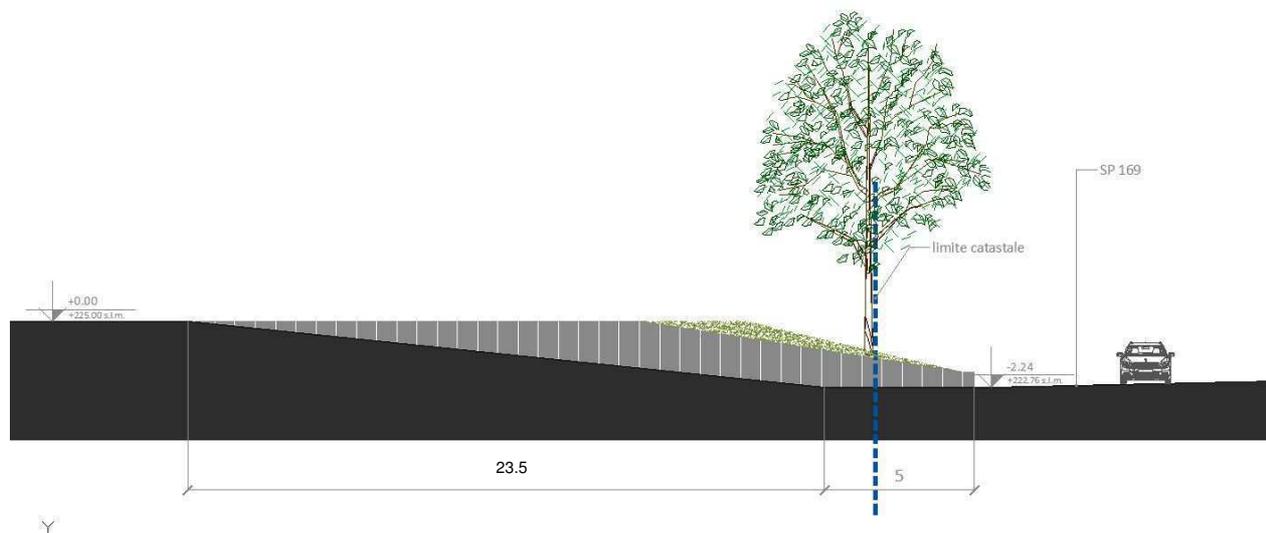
sezione dell'innesto proposto, è previsto un tratto in piano di 5 metri prima dell'innesto alla strada di tipo C a vantaggio di sicurezza.
